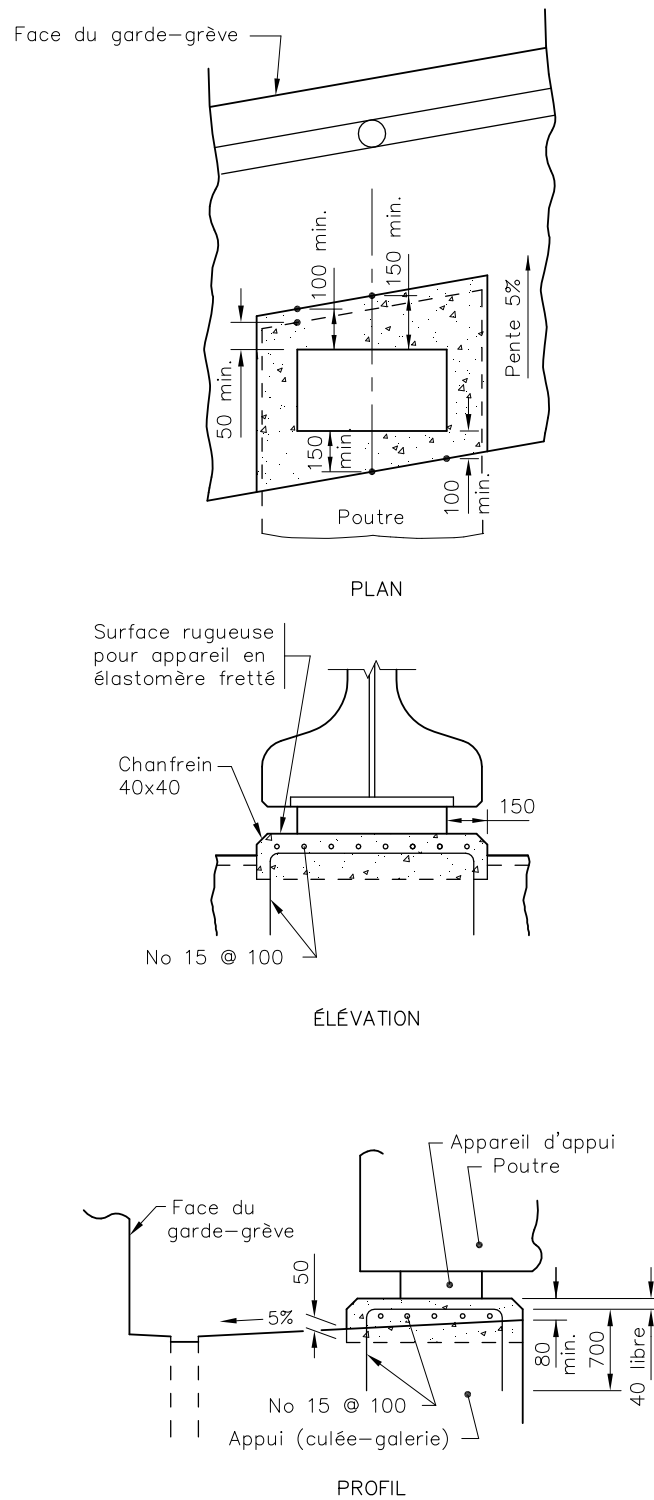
Bloc d'assise d'un appareil d'appui (Extrémité de la dalle avec joint de tablier)
